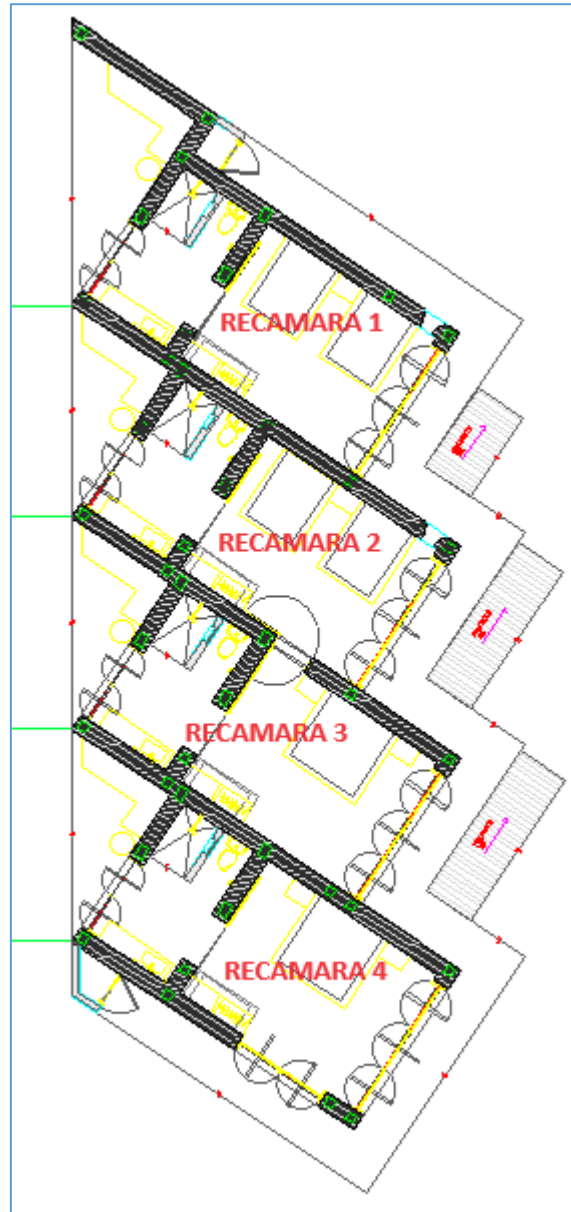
PLANO DE RECAMARAS DE (dela 1 a la 4).
